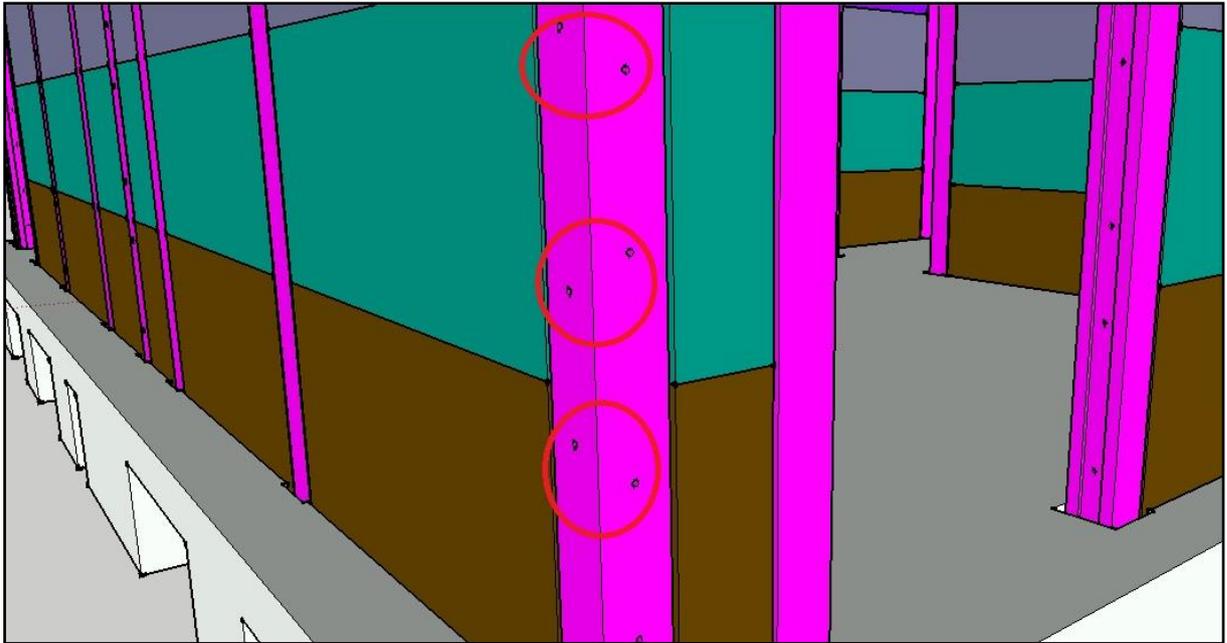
Instalação dos pilares e a primeira fiada das placas pré-moldadas
